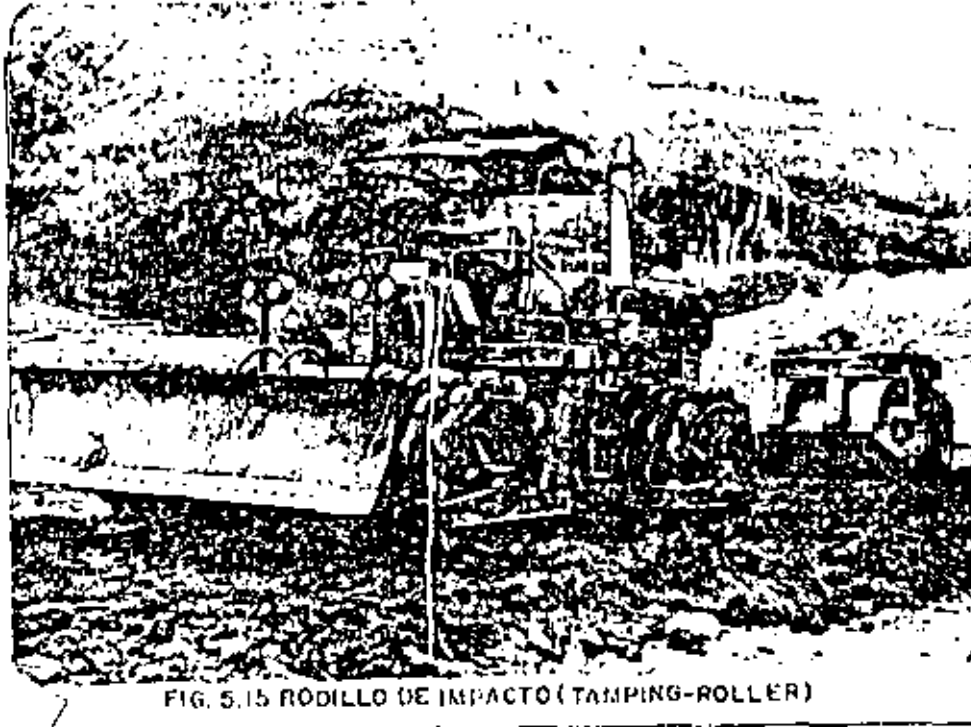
RODILLO DE IMPACTO (TAMPING-ROLLER)
